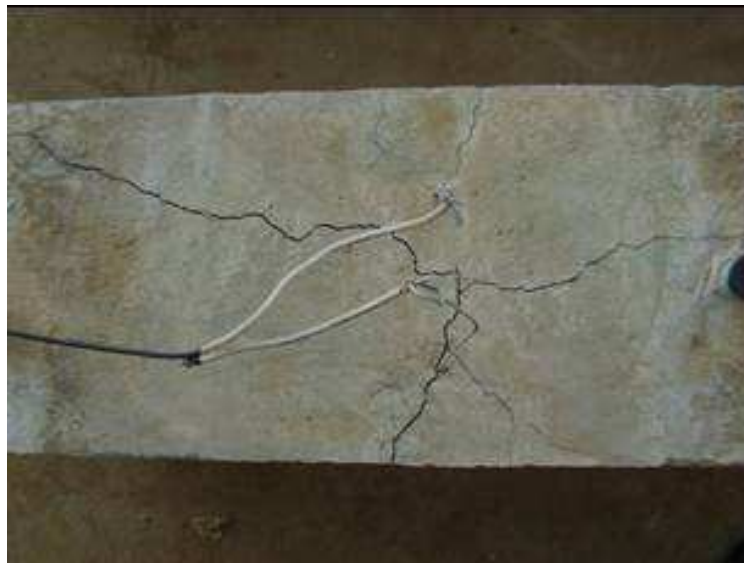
Fisuramiento crítico en viga reparada
